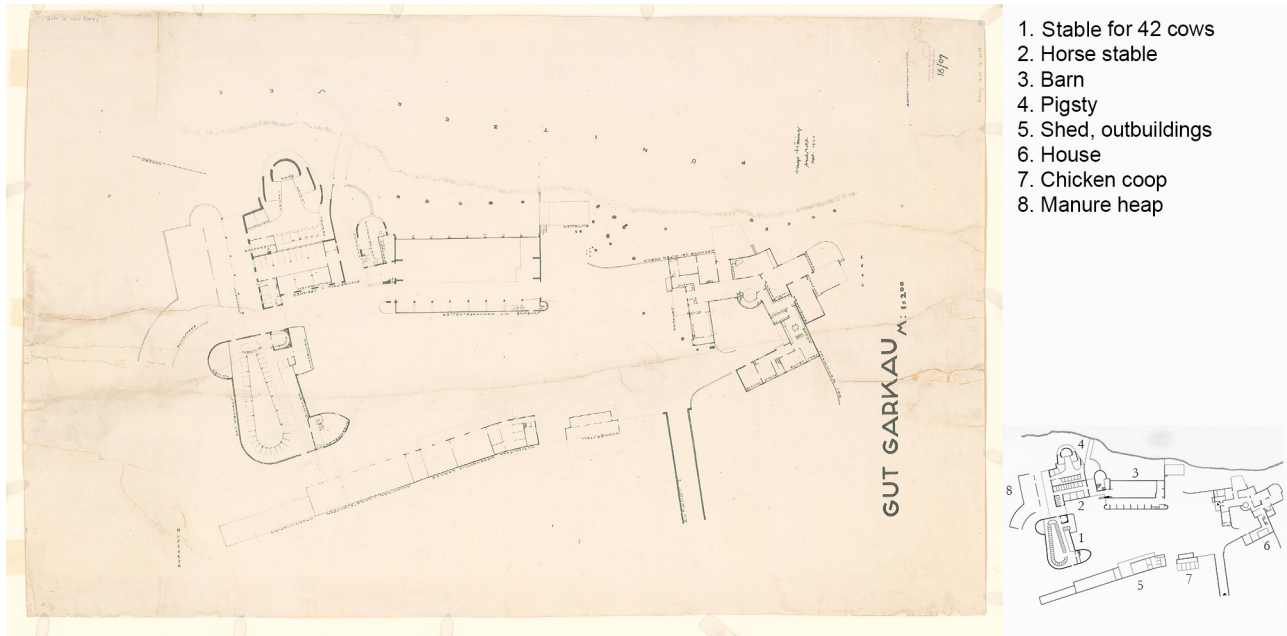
Planta de situación, Häring-Hugo_1204_018_009-1024w, Akademie der Künste, Baunkunstarchiv, Berlin.
